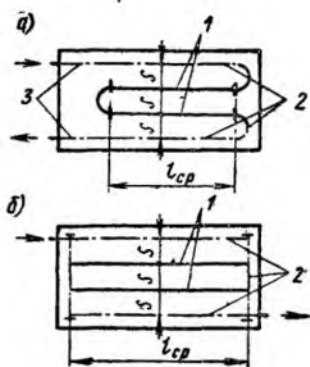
Схемы нагревательных элементов бетонной отопительной панели
